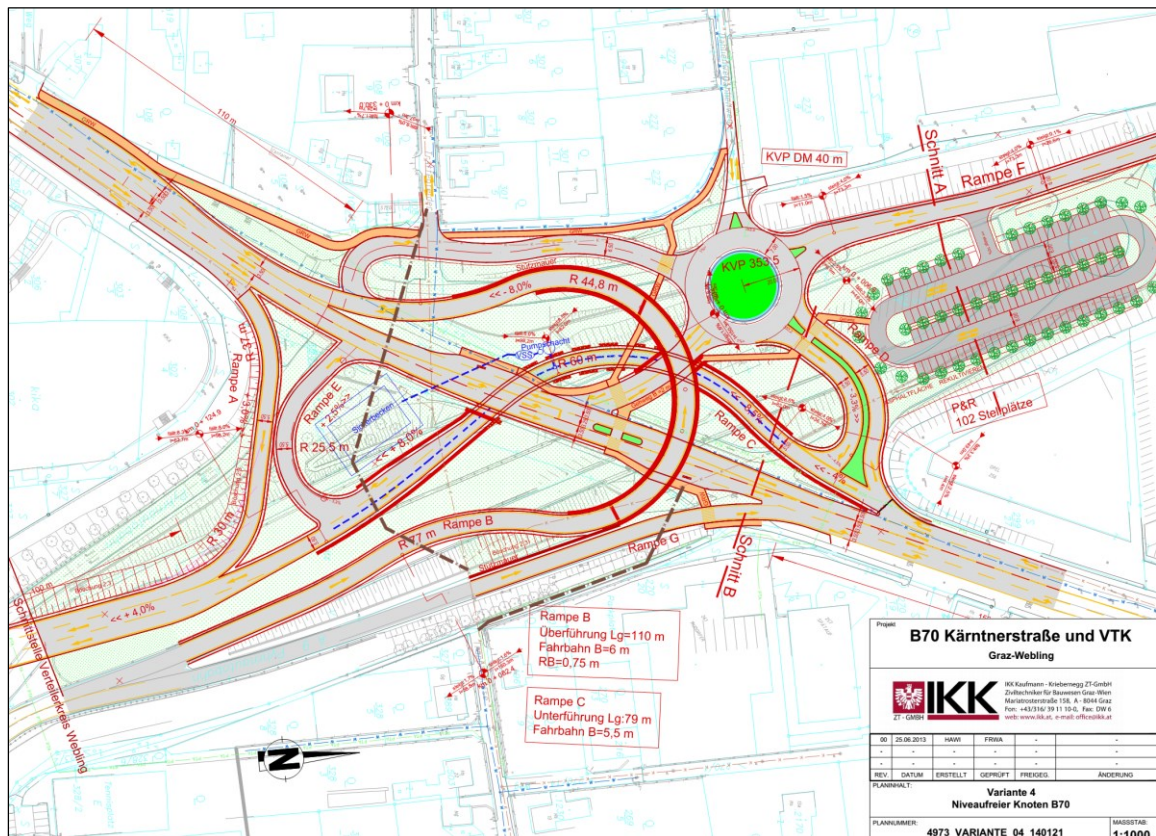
Lageplan Variante 4 - niveaufrei Lösung
